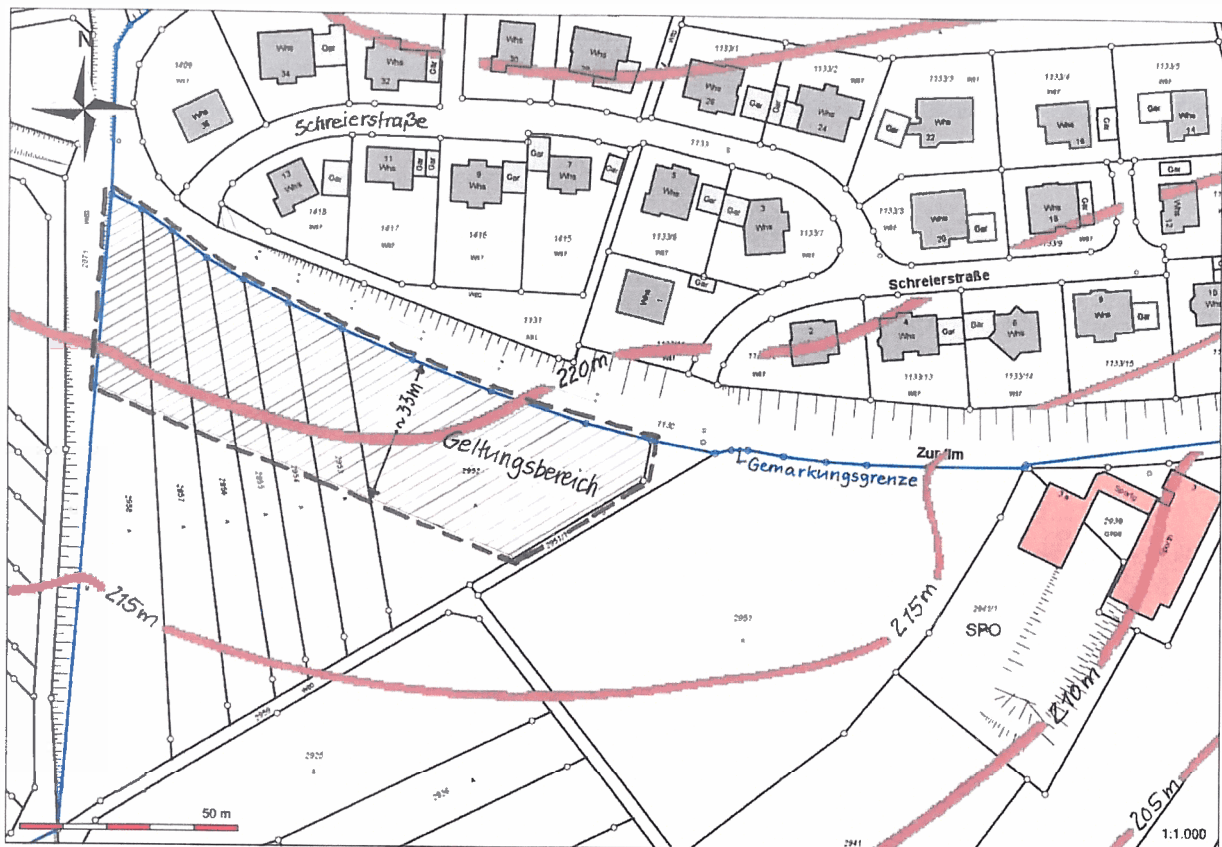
Übersichtsplan mit Geltungsbereich „Schreier III“
